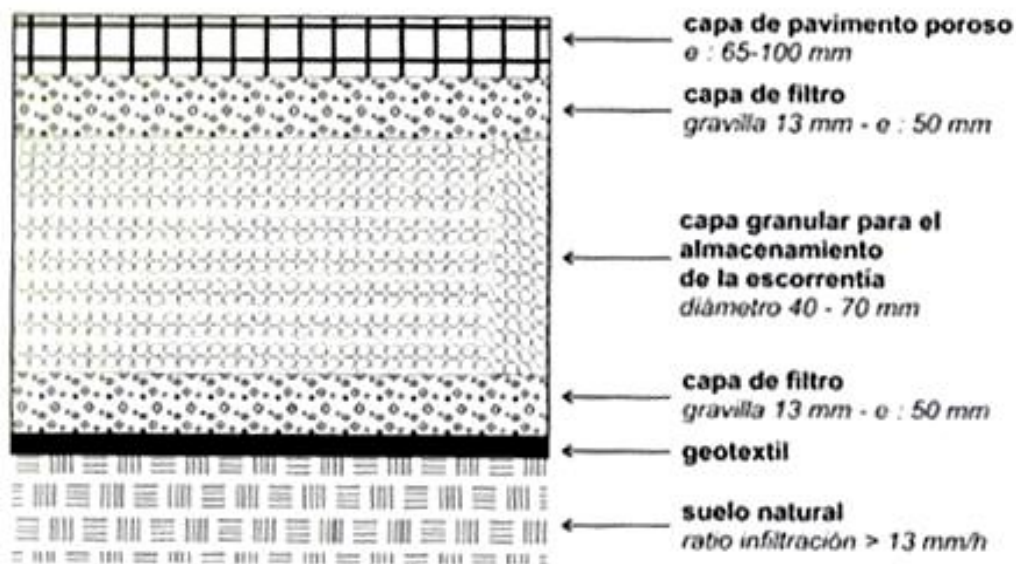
Esquema de pavimento permeable. Fuente: CEDEX (2008).
